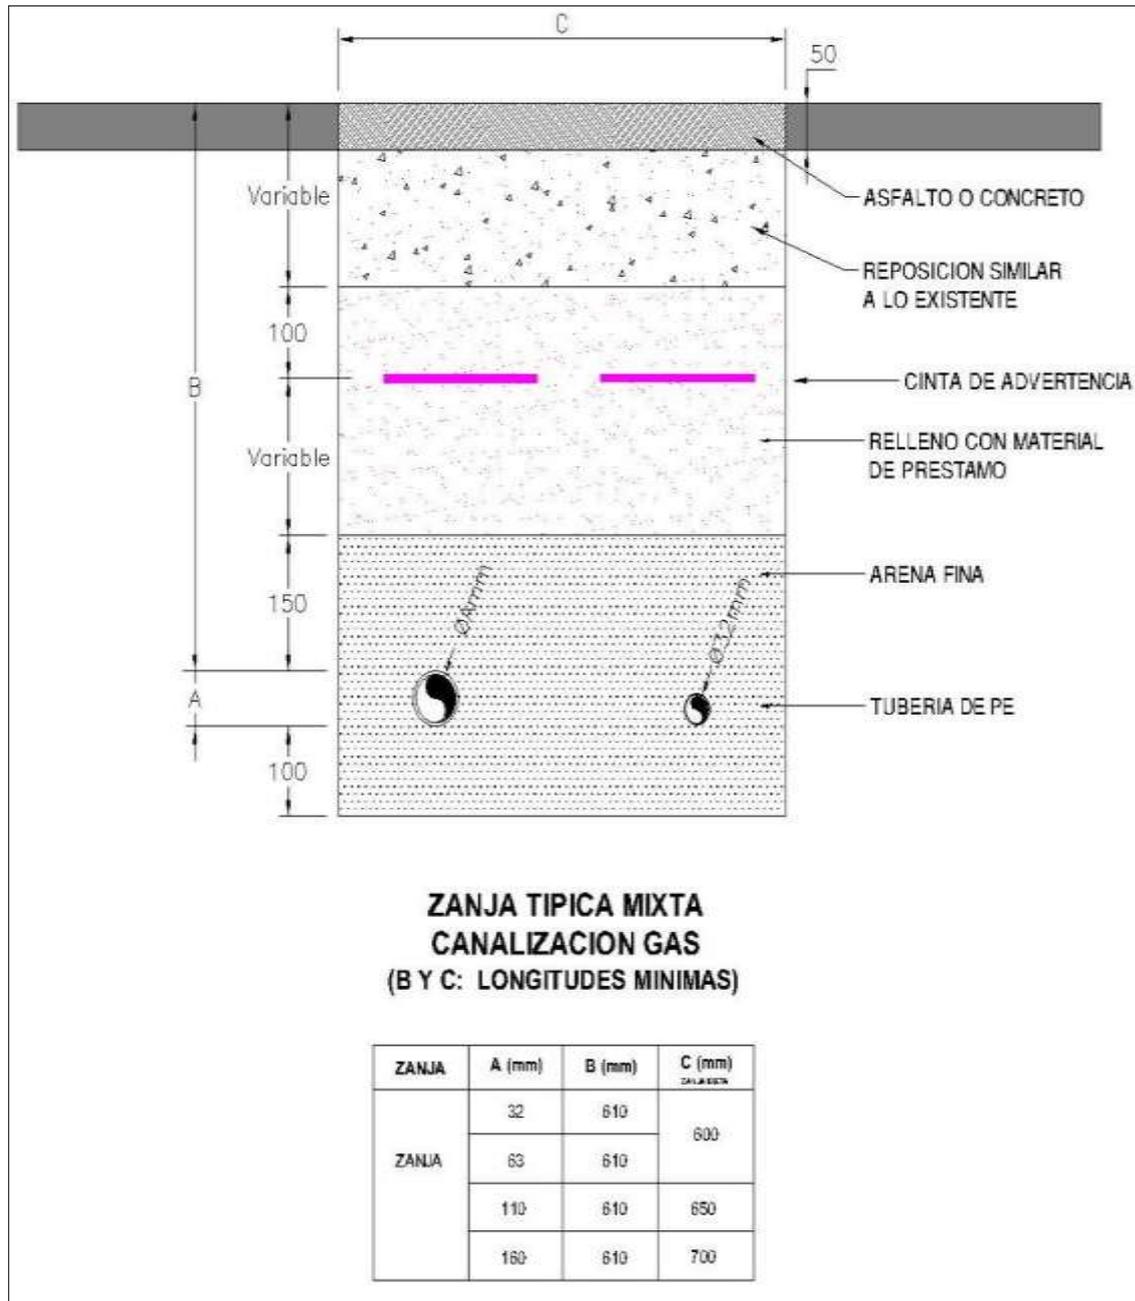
Plano Típico de Zanja Mixta para Tuberías de Polietileno
